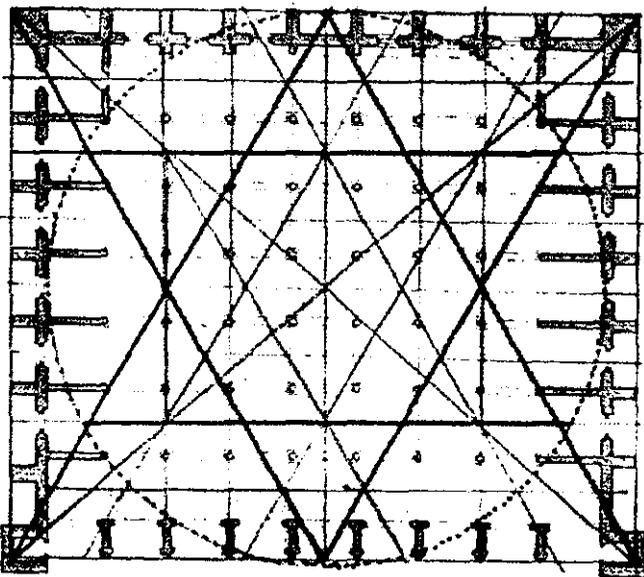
Trazo de la planta de la capilla de Cholula, Puebla.
